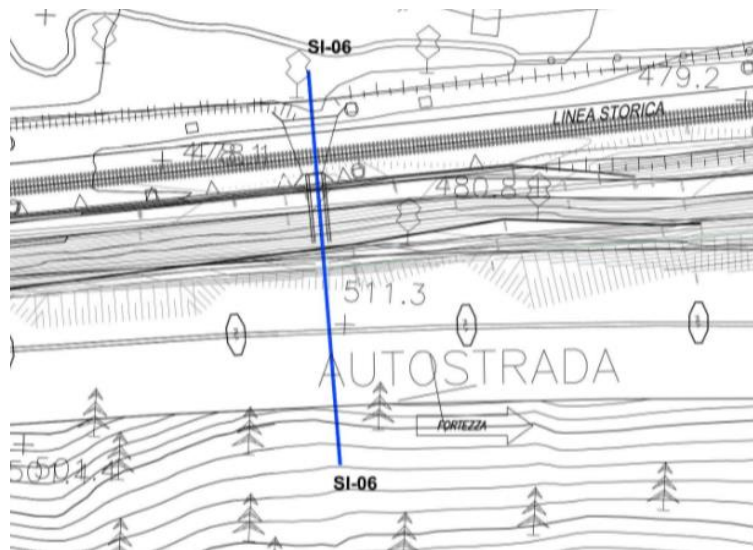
Stalcio planimetria sottoservizi del sub-lotto
